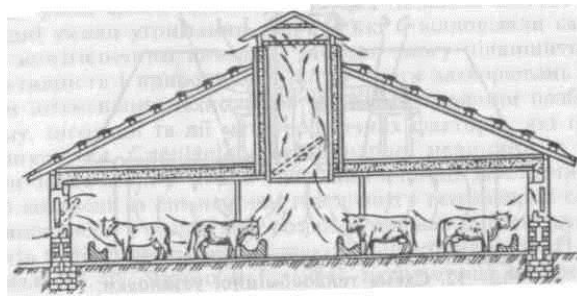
Схема будови однострубною вентиляції та розріз вентиляційної шахти
